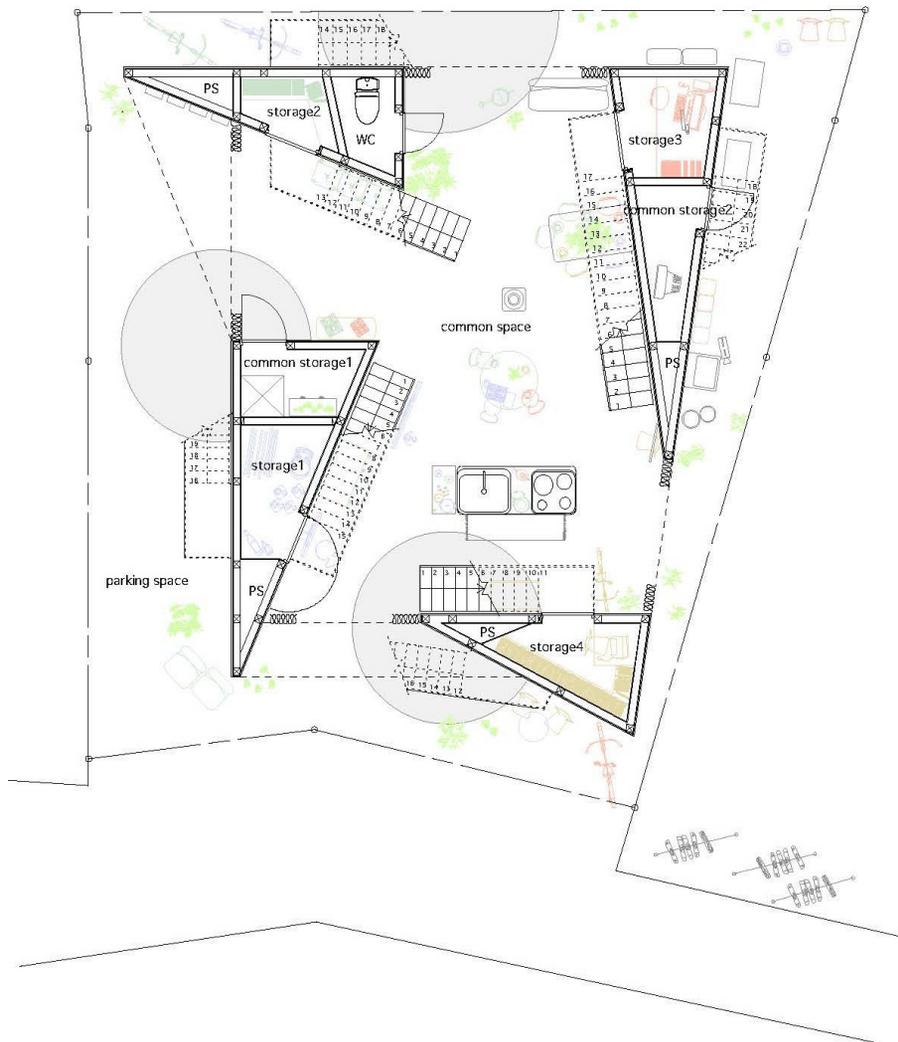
Yokohama Apartment, On design partners, Grundriss
